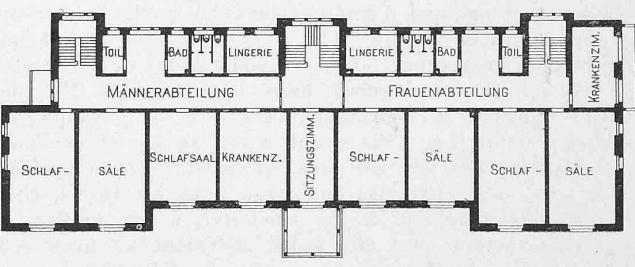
Grundriss vom ersten Obergeschoss.
